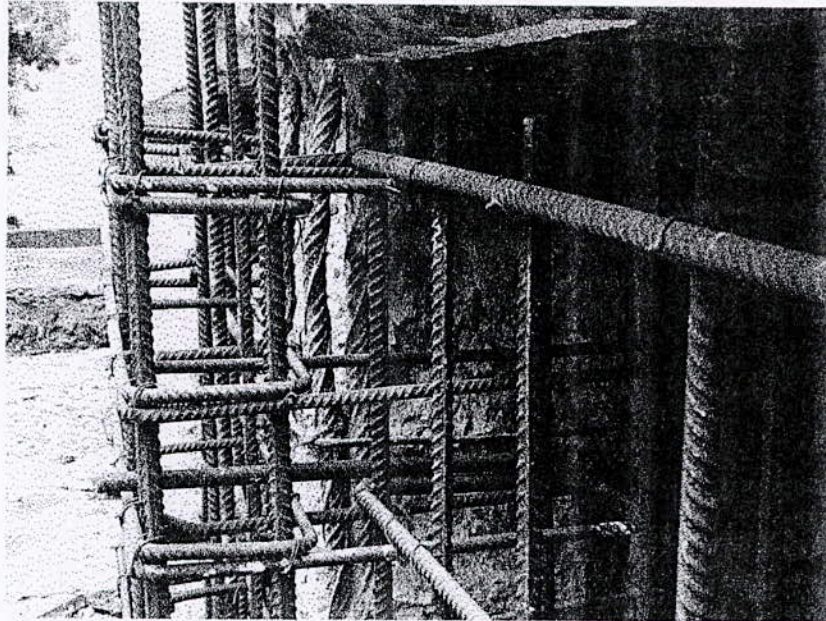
Ferrailage du voile surélevant le mur de soutènement
